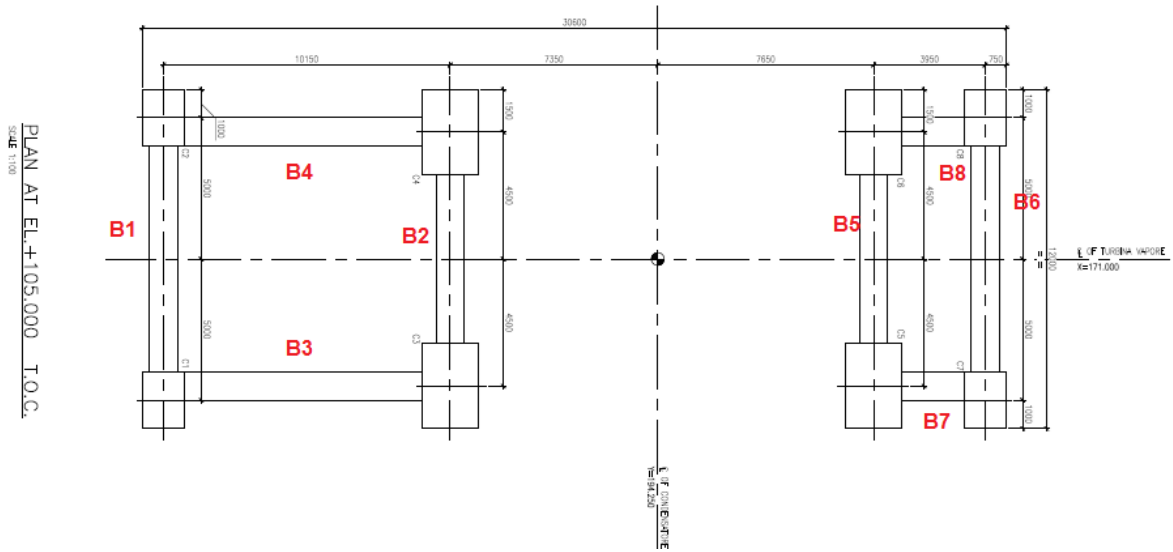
Pianta elevazione +105.00 da T.O.C.
